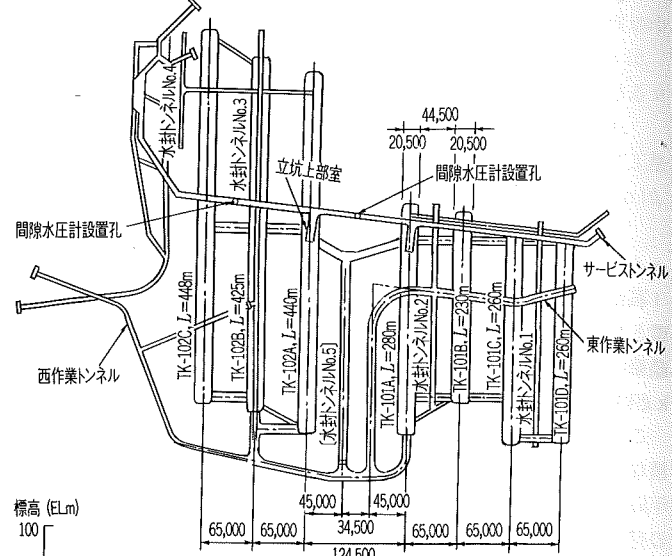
菊間基地平面および断面図(間隔水圧計設置図)
